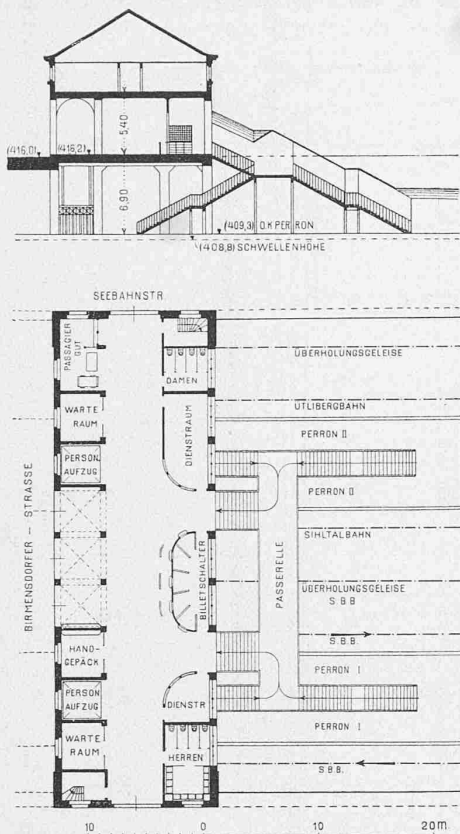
Grundriss und Schnitt 1:600 des Aufnahmegebäudes Wiedikon für S. B. B., Sihl-T.-B. und Uetlibergbahn.
